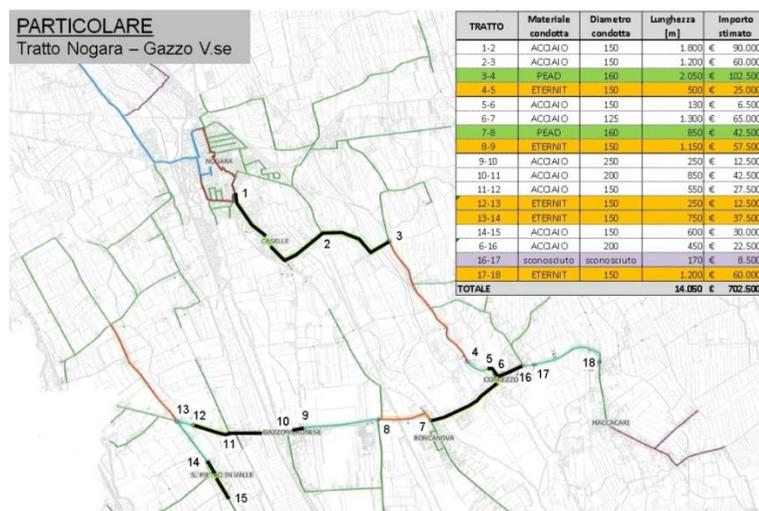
Stralcio planimetrico con l'individuazione dei tratti di rete da adeguare.
